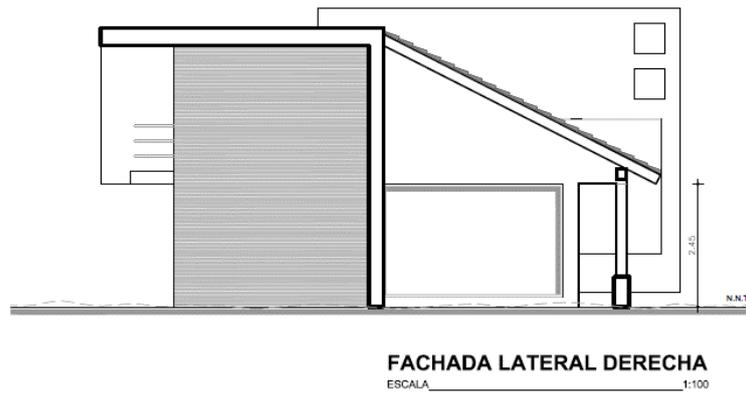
Fachada Lateral Derecha Casas 20 B y 20 C
